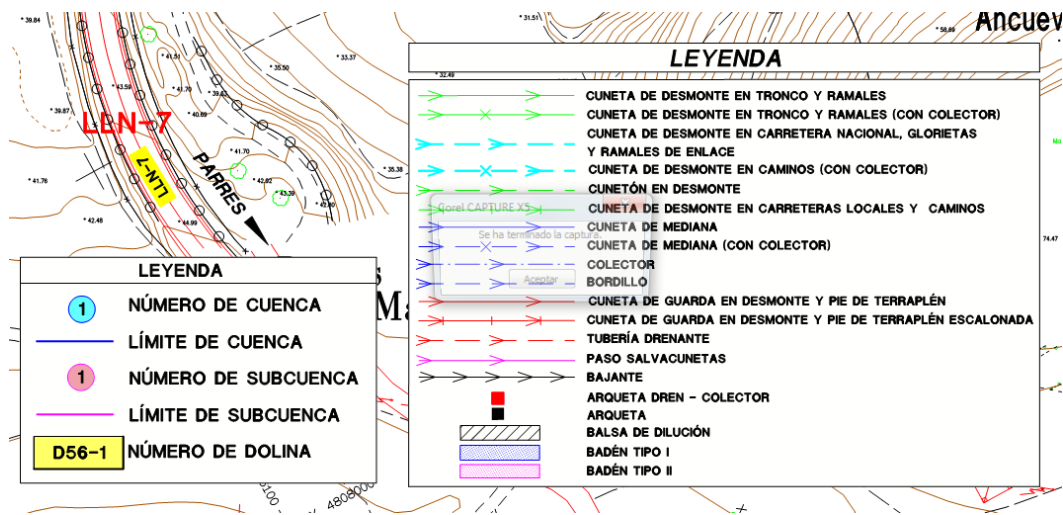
Leyenda de los planos nº9 correspondiente a los planos de planta de drenaje
